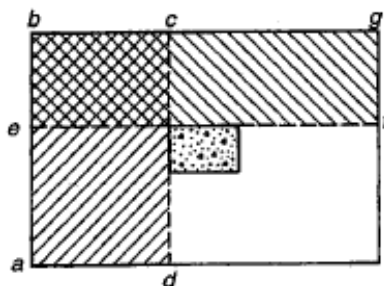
Sección crítica para flexión. (NILSON ARTHUR H, 2001)
